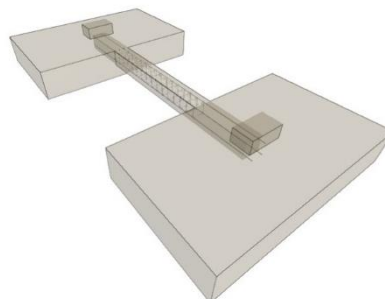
Vista 3D de la viga de atado. Fuente: CYPE 3D.
